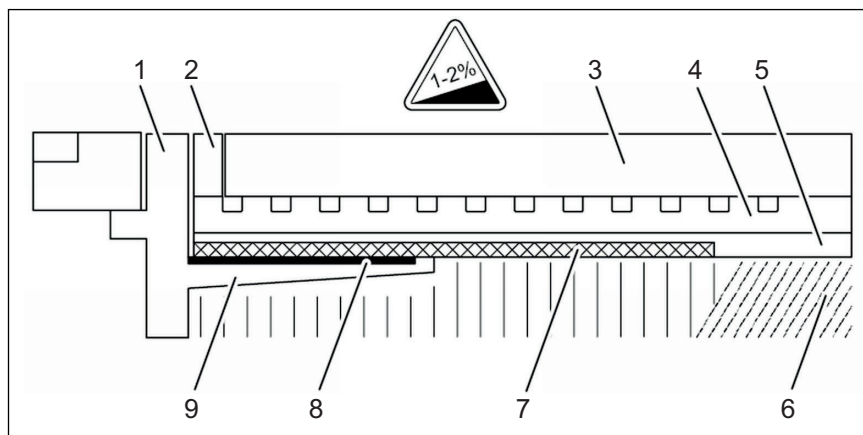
Esquema de sistema de impermeabilización compuesto: pendiente del pavimento mín. de entre el 1 y el 2%
